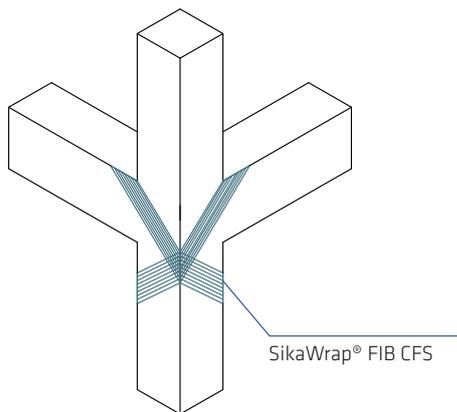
Fase 1: Rinforzo con fasce unidirezionali per pilastri d'angolo e pilastri perimetrali intermedi
